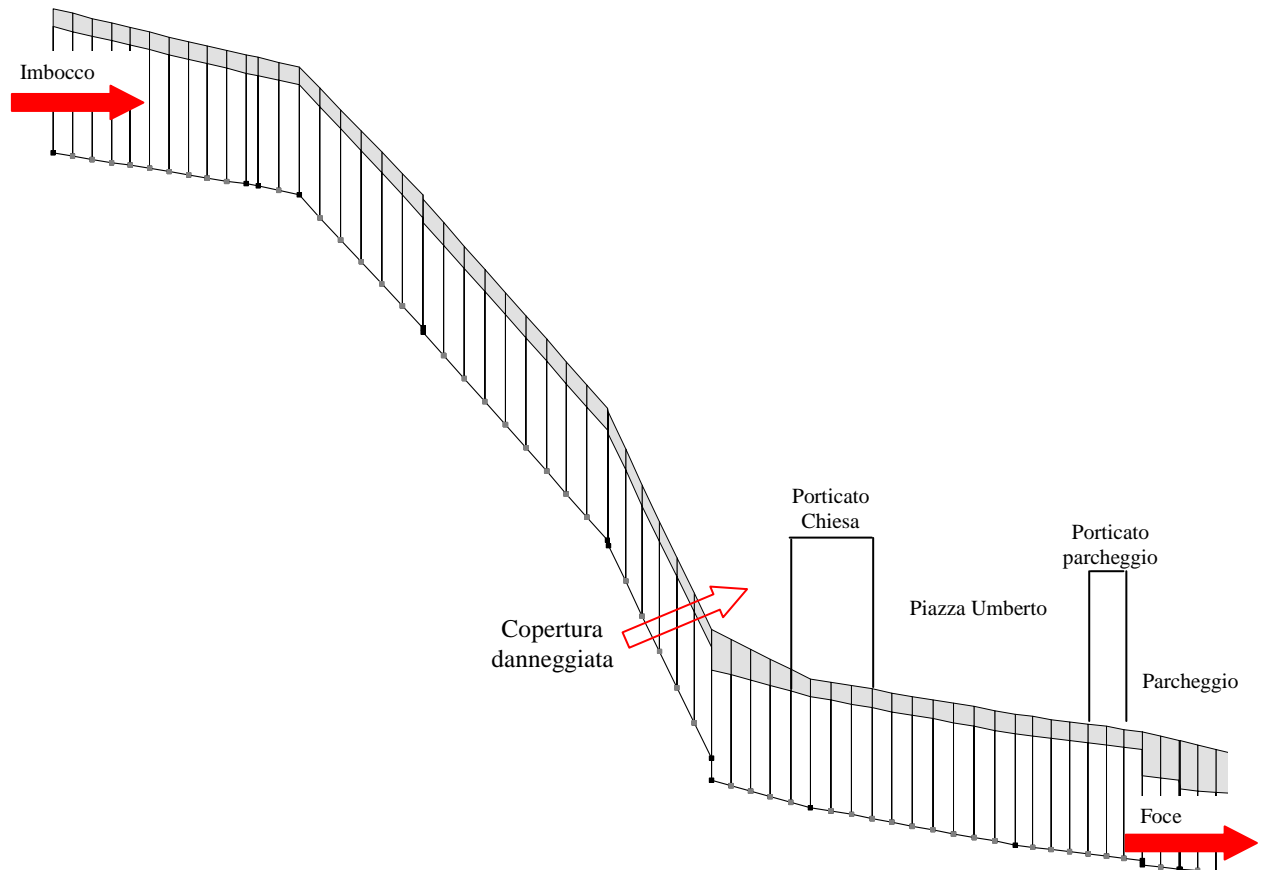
Profilo longitudinale alveo tombato torrente Dragone
